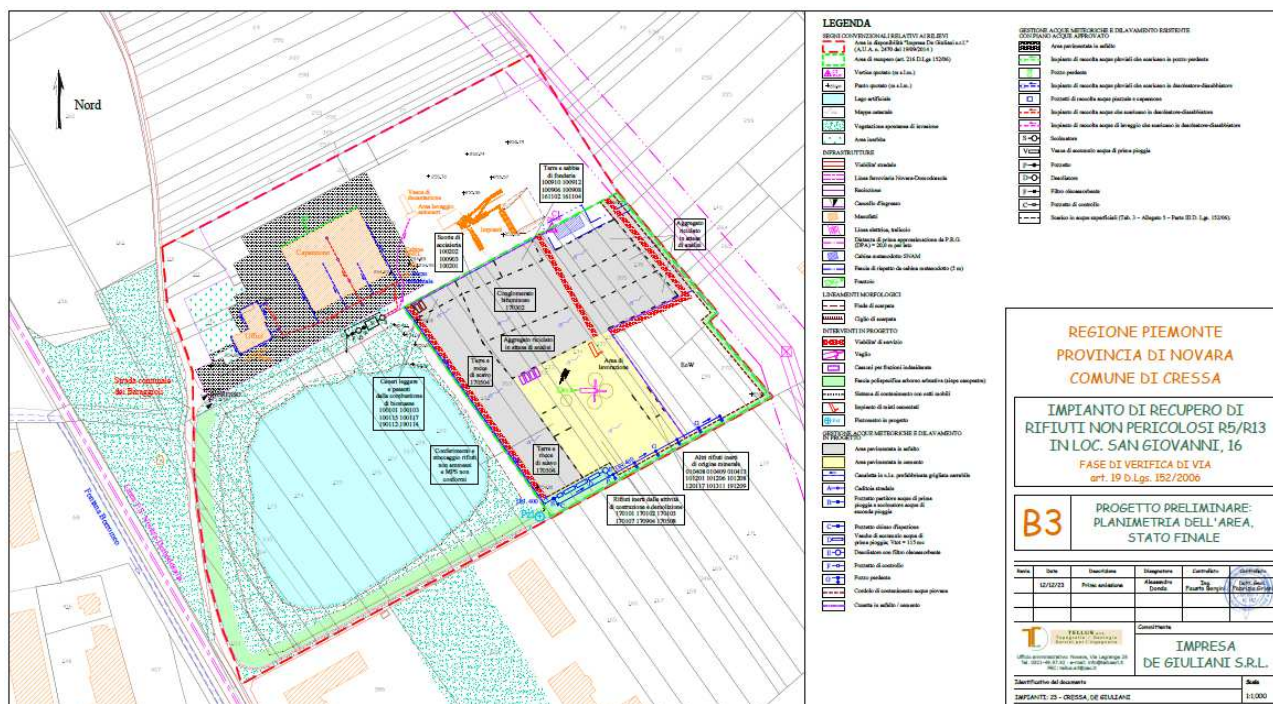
Planimetria impianto-stato finale (tavola B3)
